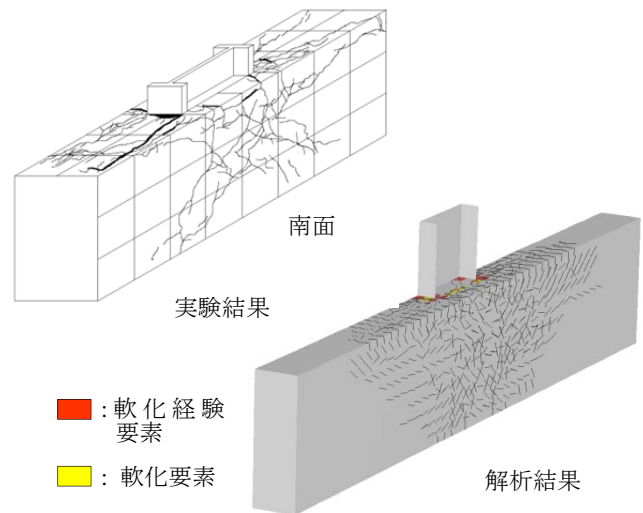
柱側面ひび割れ図 (RCS-15)
